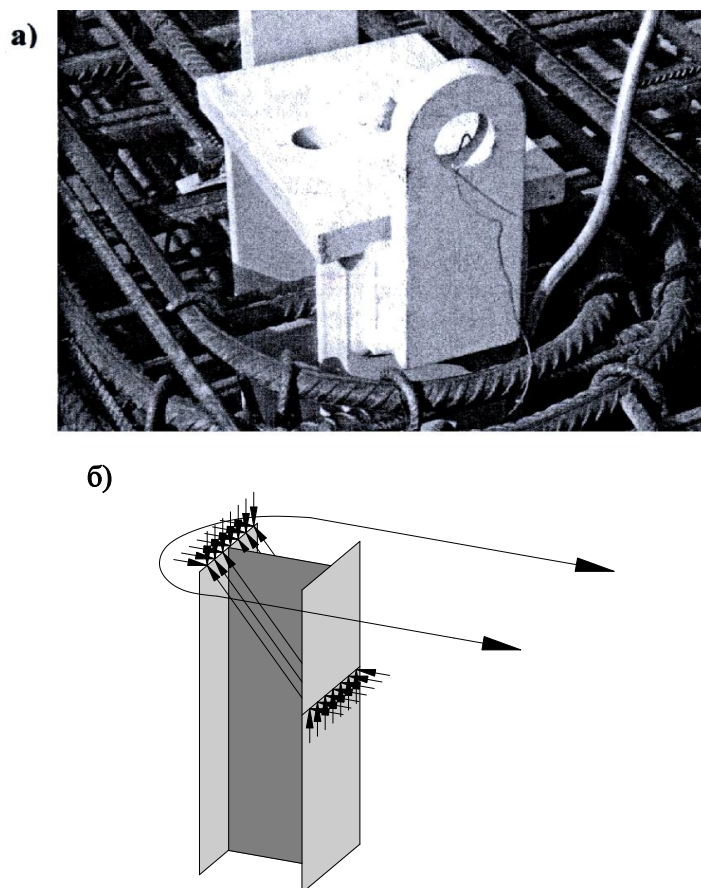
Армирование железобетонного перекрытия в зоне сопряжения с сталежелезобетонными колоннами крайнего ряда [7]
